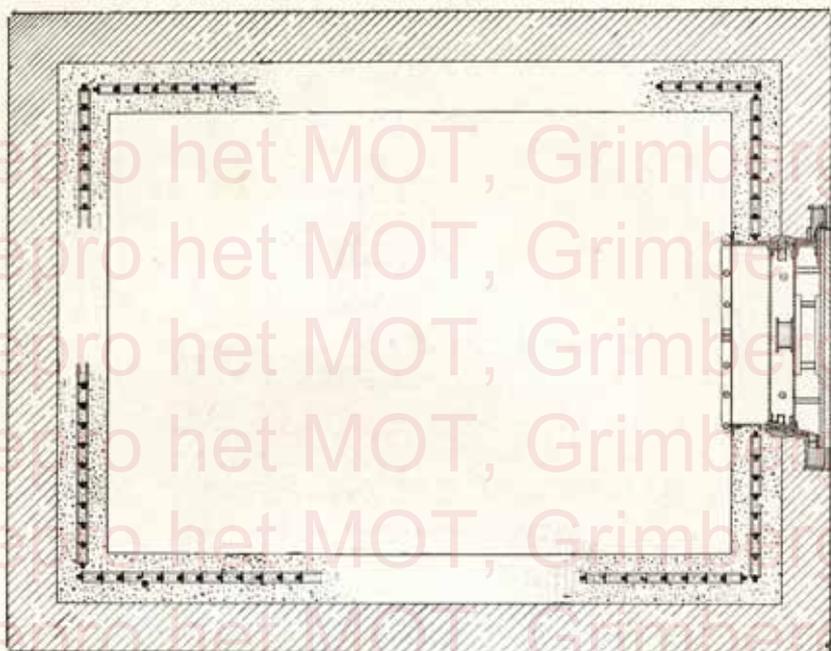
Plan de coffre-fort — armature simple — Système Kahn
